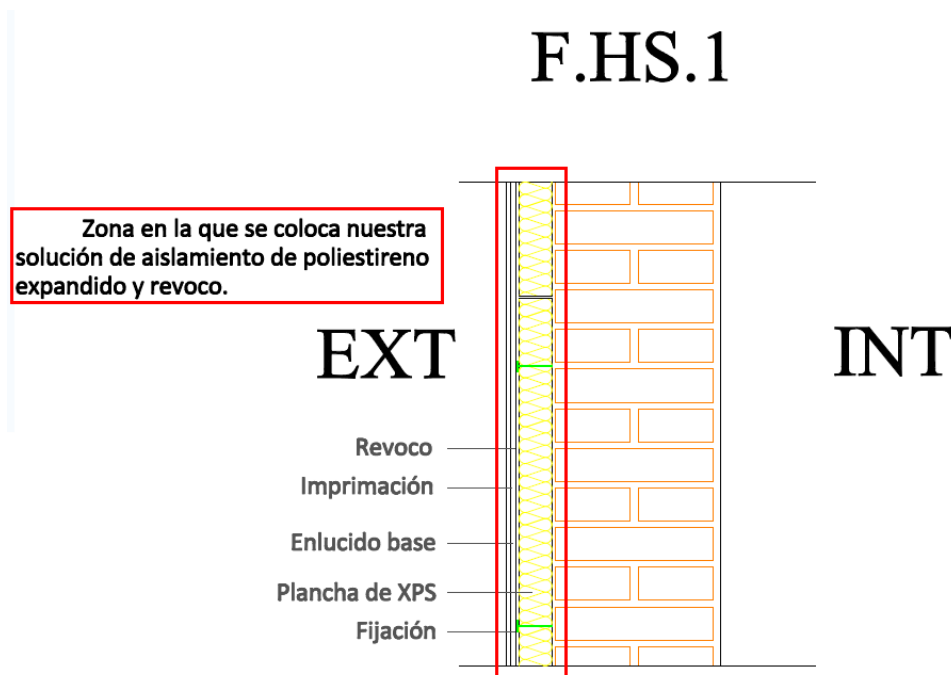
Detalle reforma exterior EPS bajo revoco
